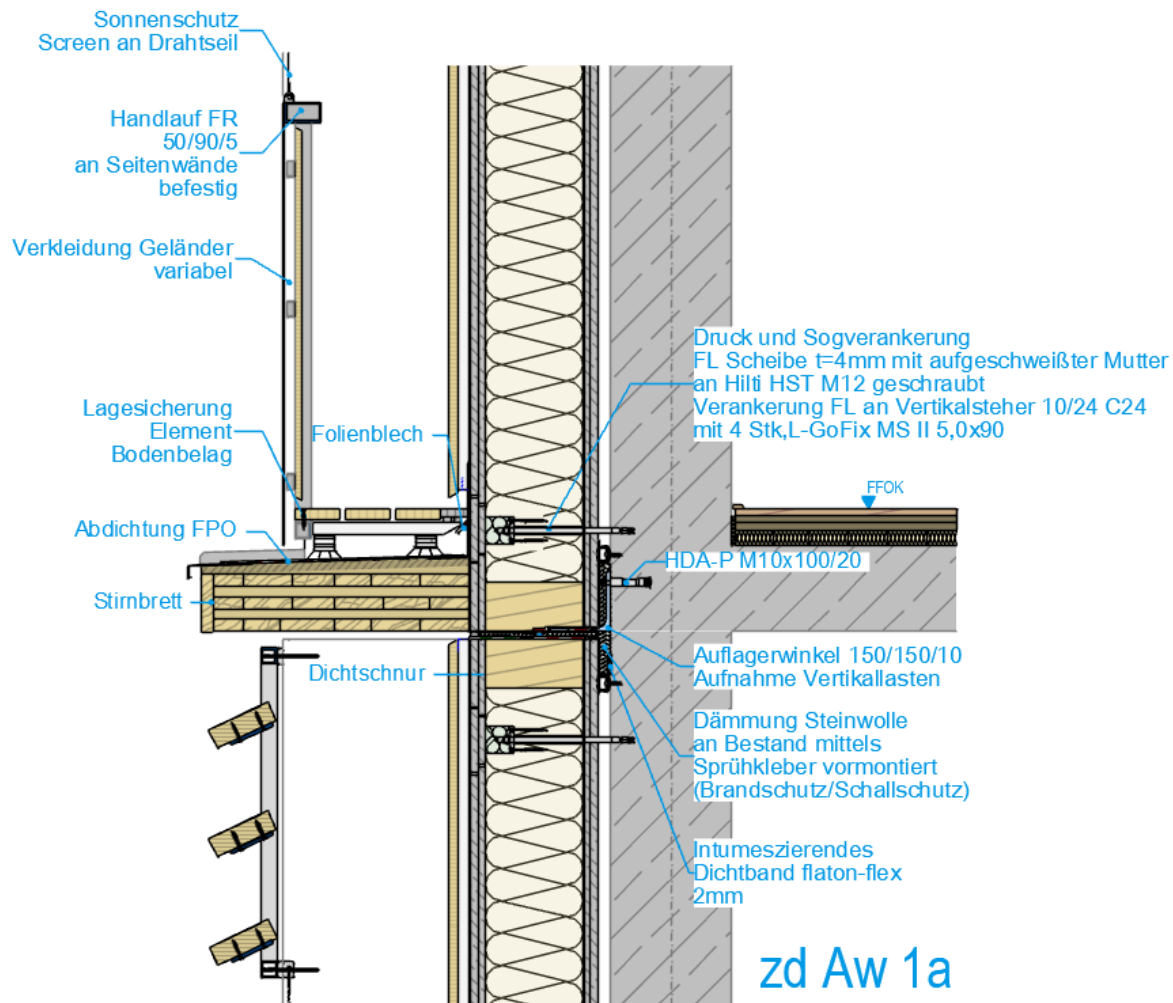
/ Aw 1a – zd - Detail Elementübergang
